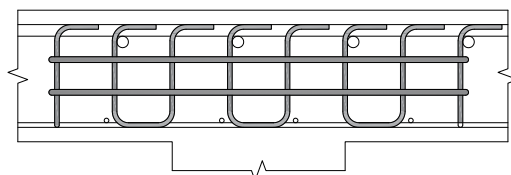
Estribos utilizados por PILAKOUTAS e LI (1997)
